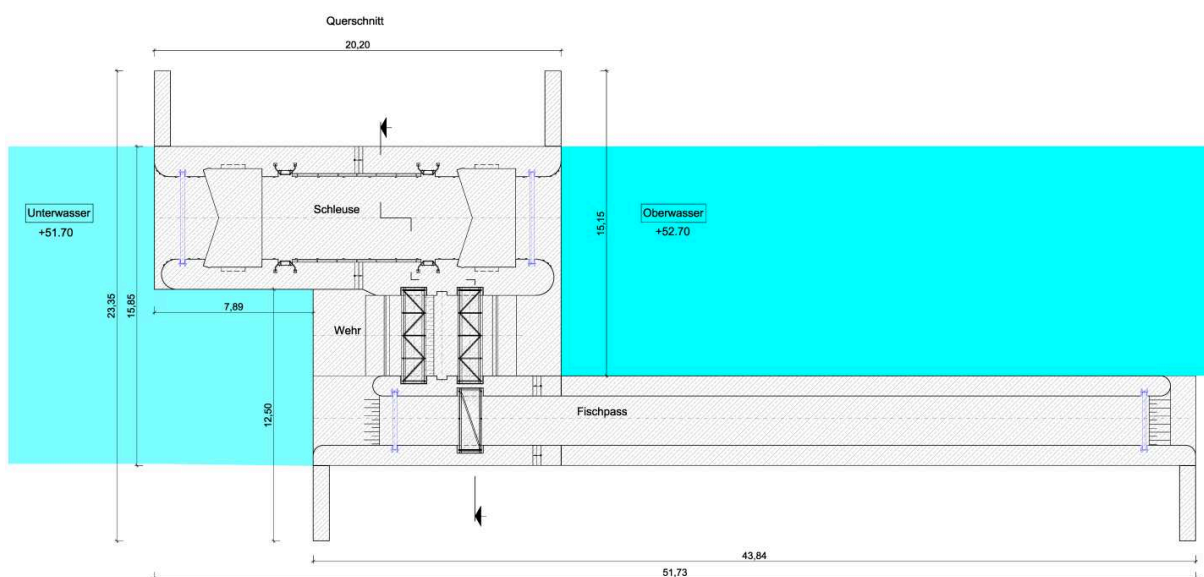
Geplantes Bauwerk Ersatzneubau Wehr 65
